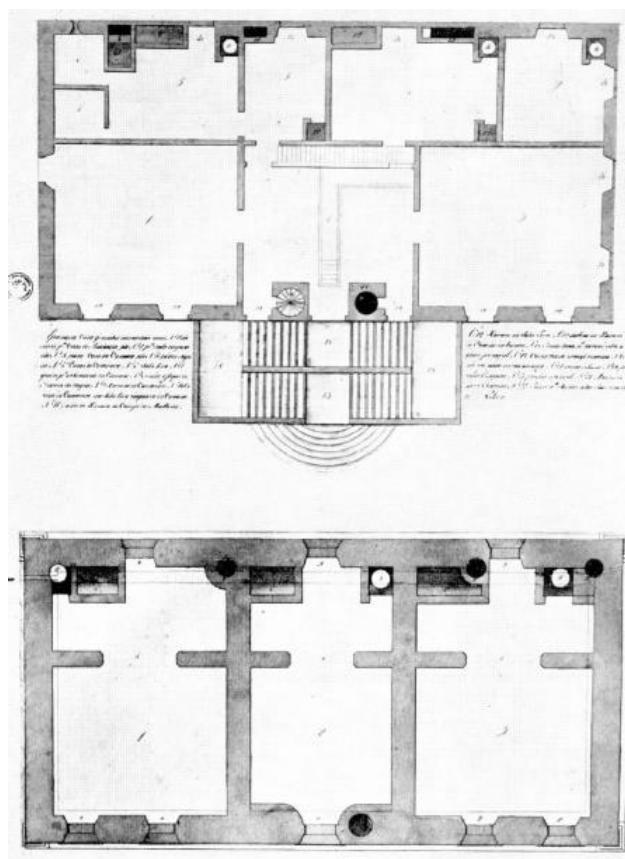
Planta baixa da casa de câmara e cadeia mariana
